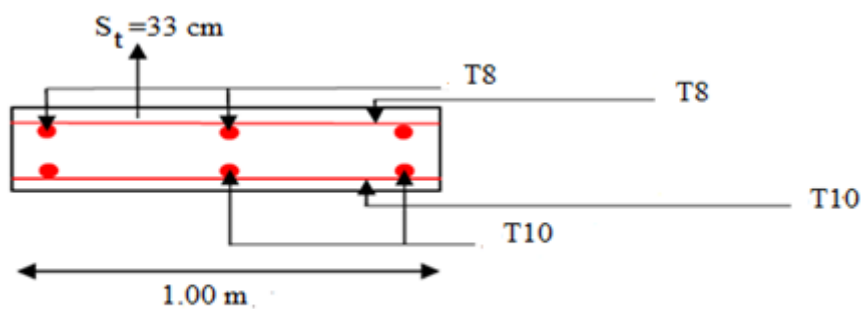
Schéma de ferrailage de la dalle au-dessous de l'ascenseur
